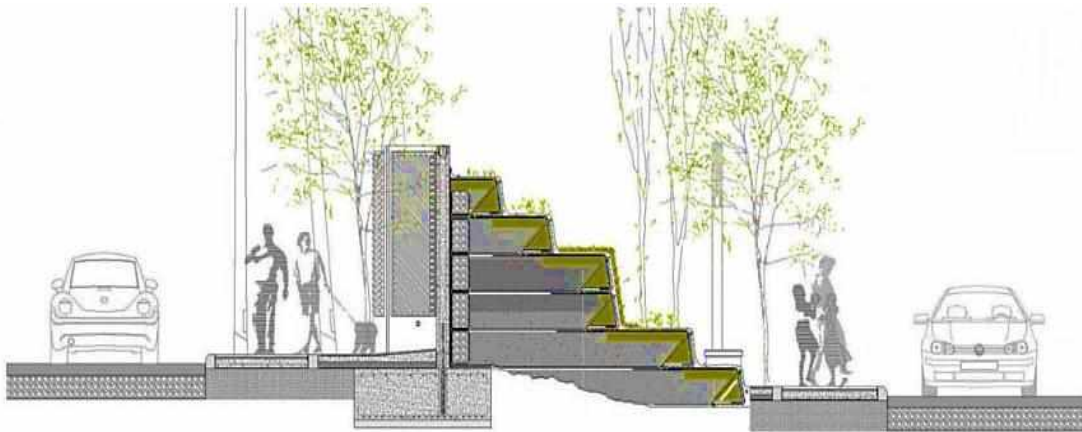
Barrera mixta de hormigón roto y vegetación en Madrid
